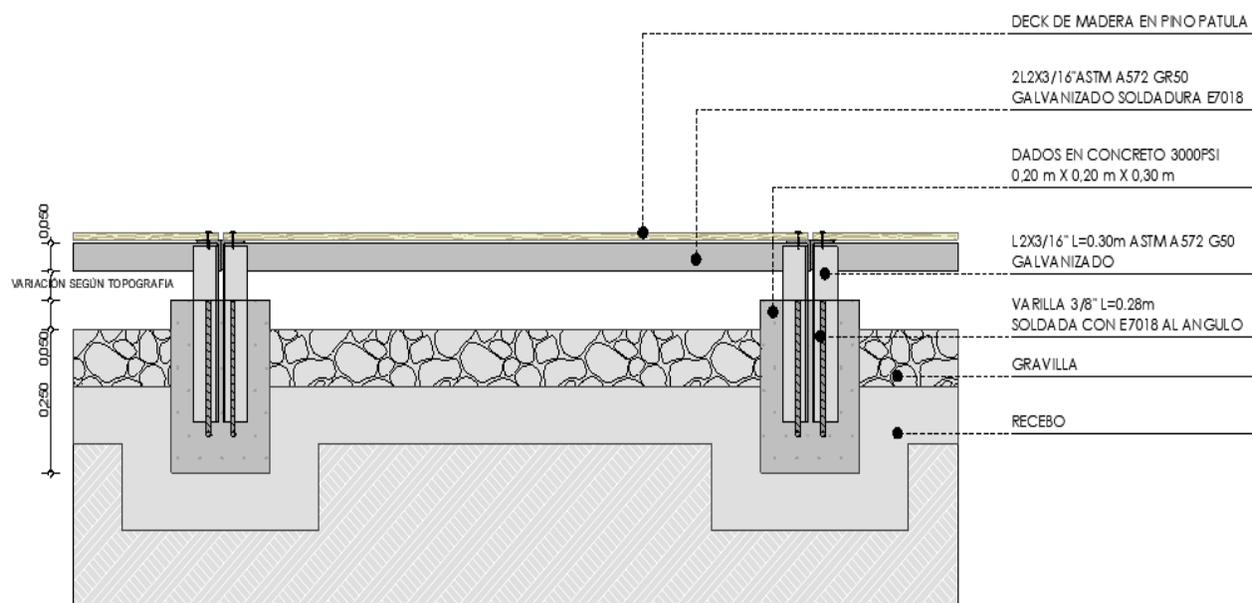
Detalle constructivo piso en madera V-A*Figura 134.*Detalle constructivo piso en madera Corte A
